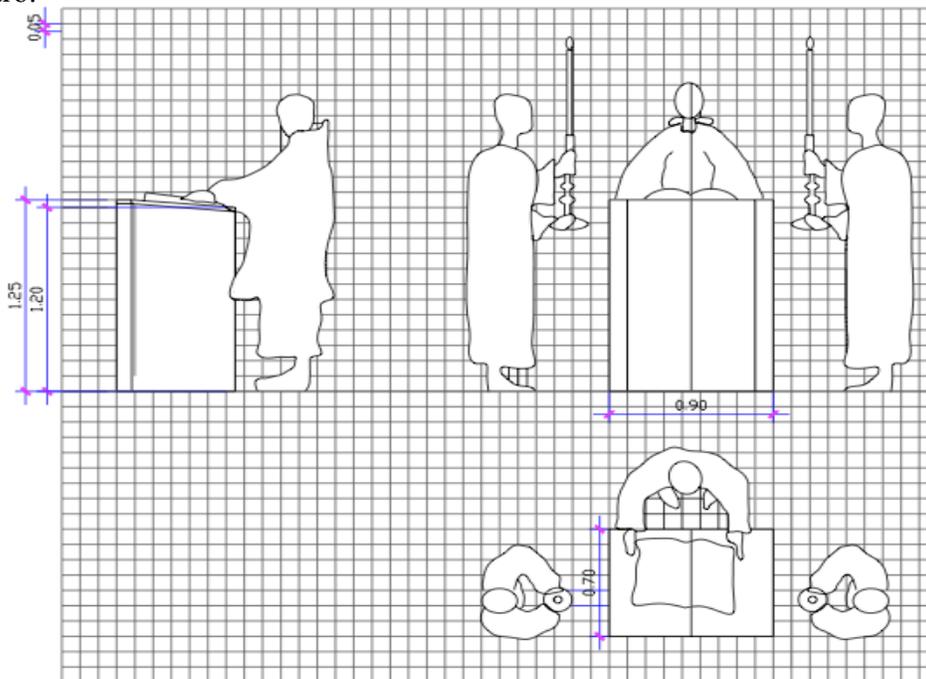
“Antropometría de Ambón” Fuente: Autoría Propia
